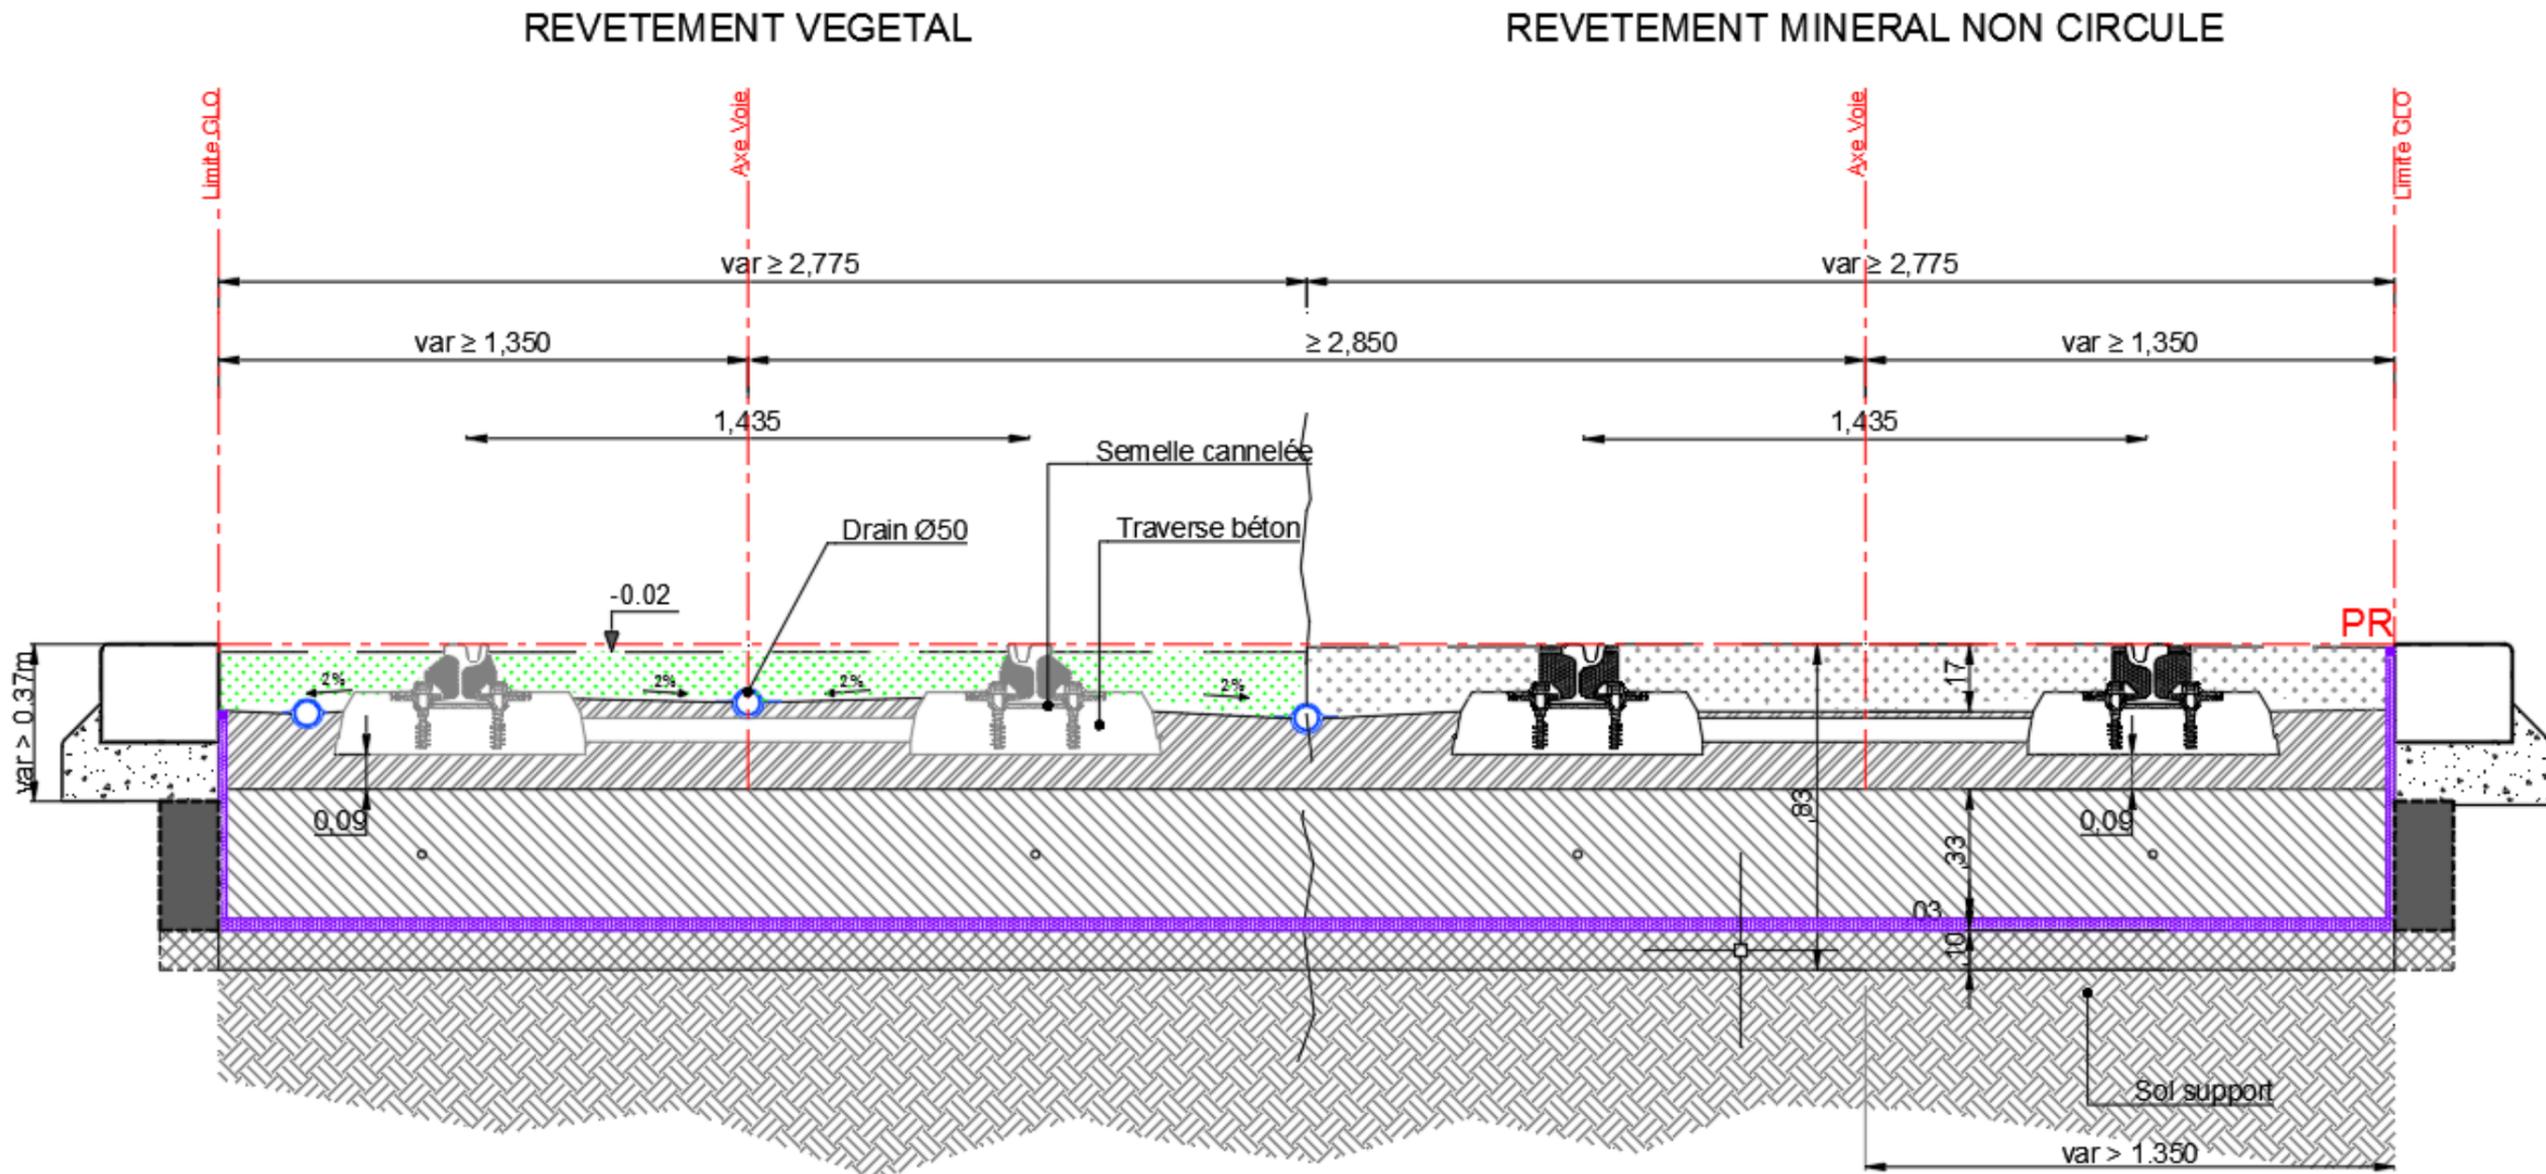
Profil en travers type de la plateforme de tramway (Ingerop, 2020)
